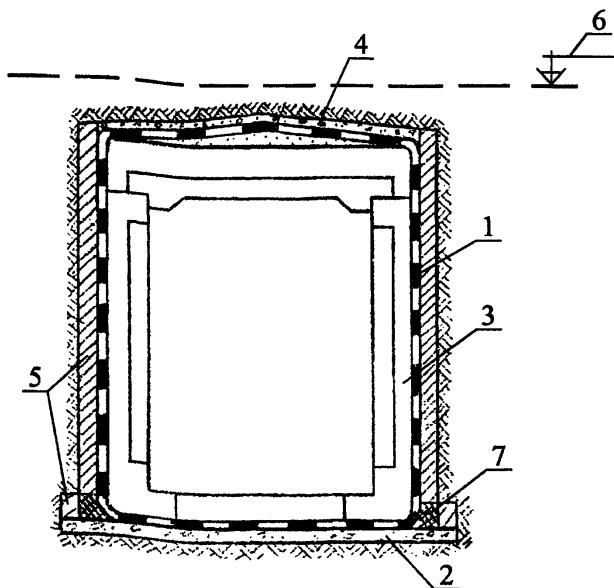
Гидроизоляция подземных сооружений от напора грунтовых вод
